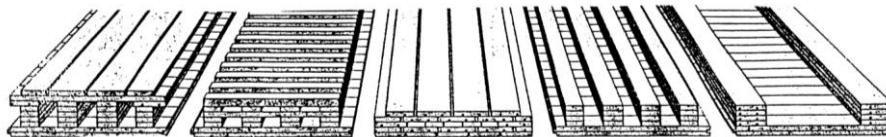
Виды клеёнодощатых плит покрытий и перекрытий
